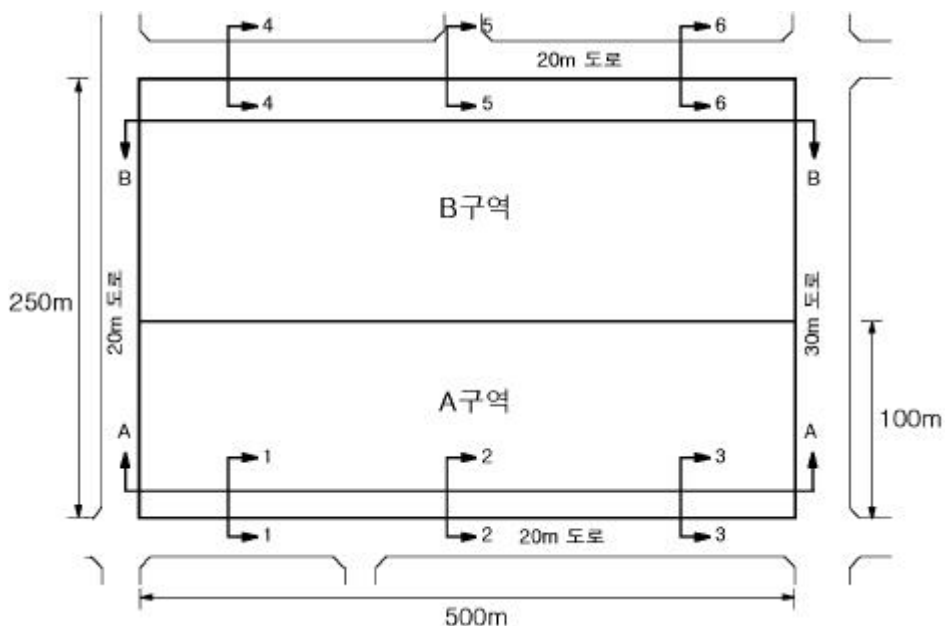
굴착시공 평면도 및 지층단면 위치도
